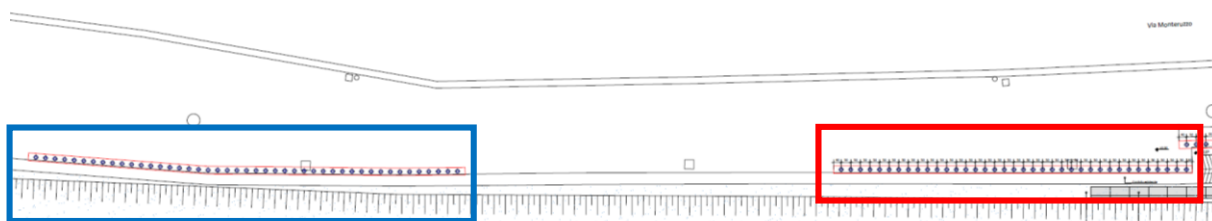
Estratto planimetrico intervento di consolidamento tratto di monte (vedi elab. 1183-D-G03-18-PLT).
